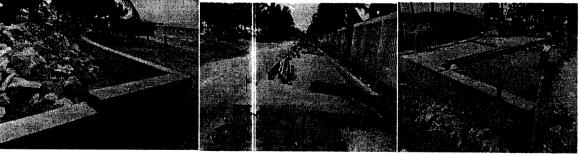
, 4 y 5. Construcción de muros de contención, pavimento rígido en un solo carril y zona peatonal.
